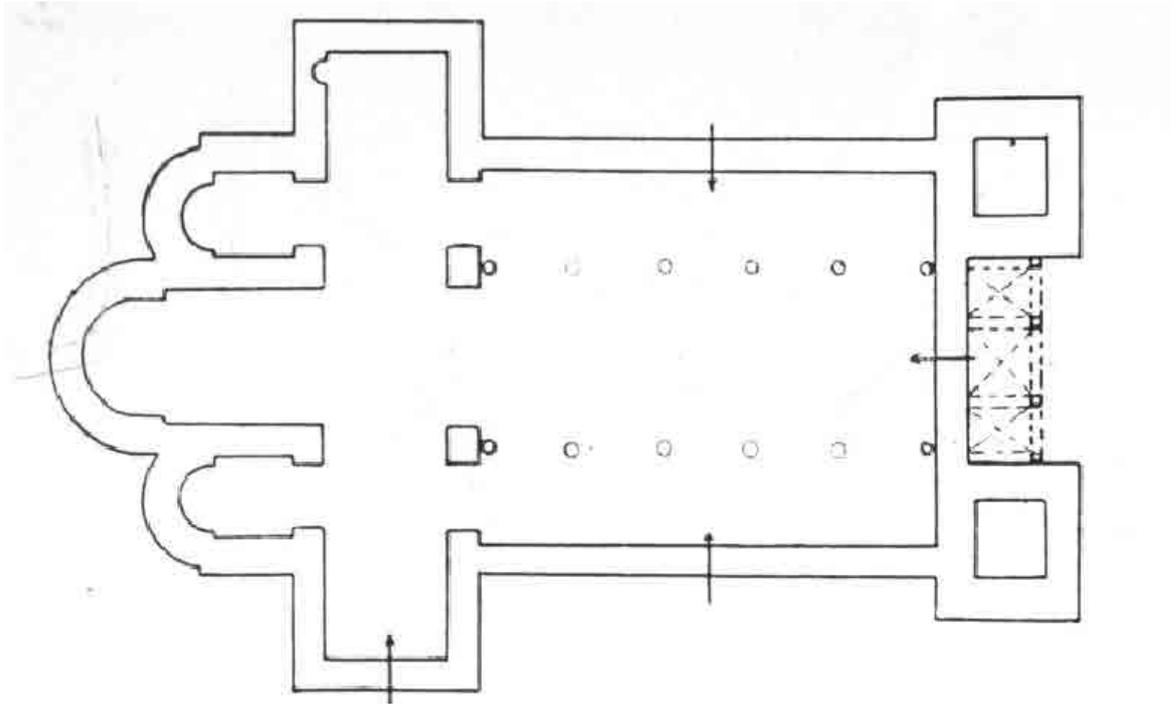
Mazara, Cattedrale, pianta (Schwarz e altri)
